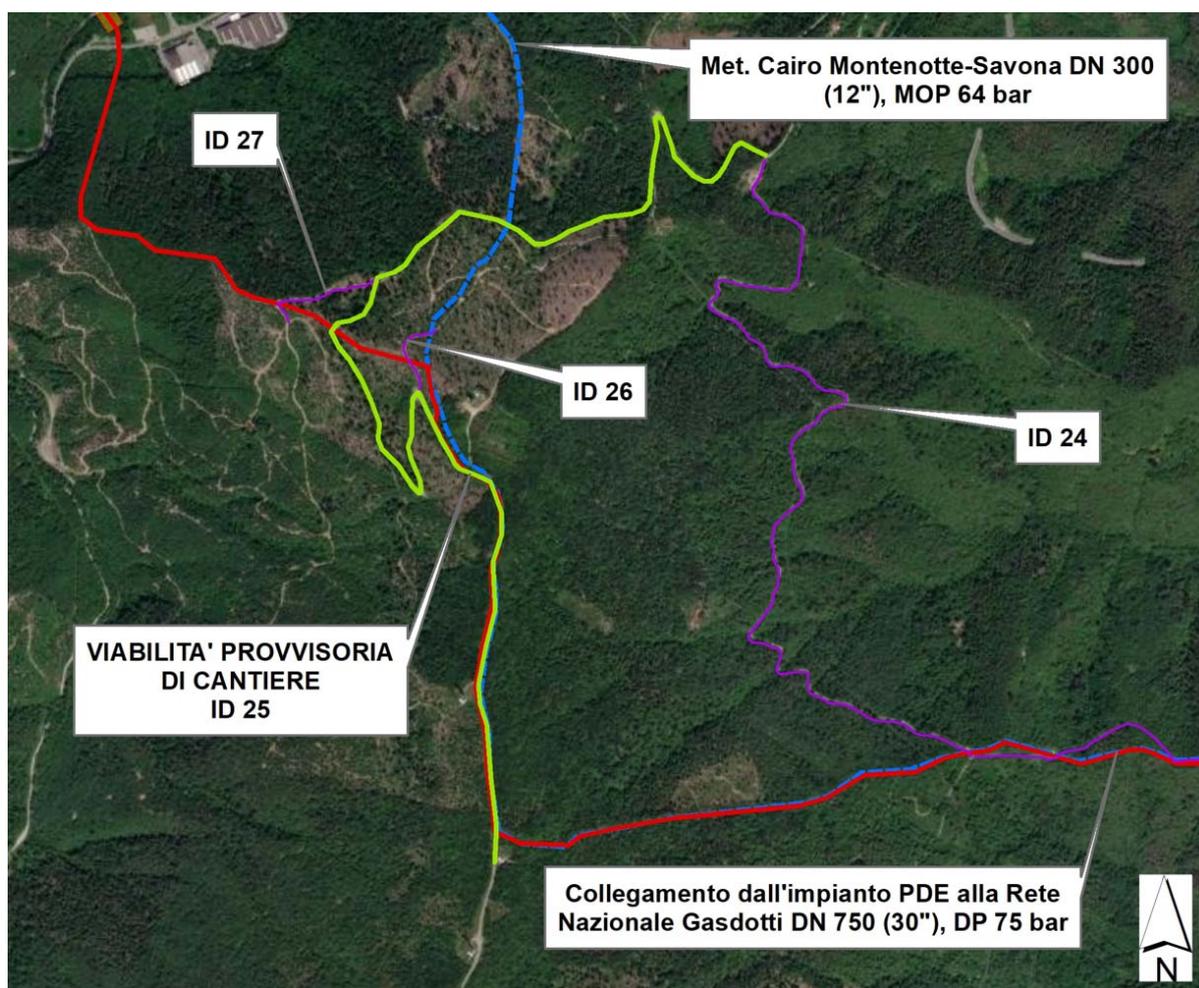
Planimetria di inquadramento della strada provvisoria di cantiere ID25
